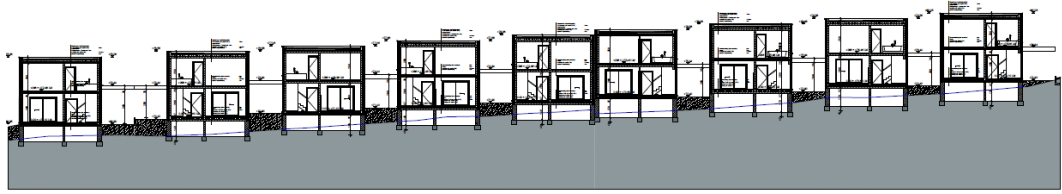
Detail van zone C met aanduiding van de huistypes.
